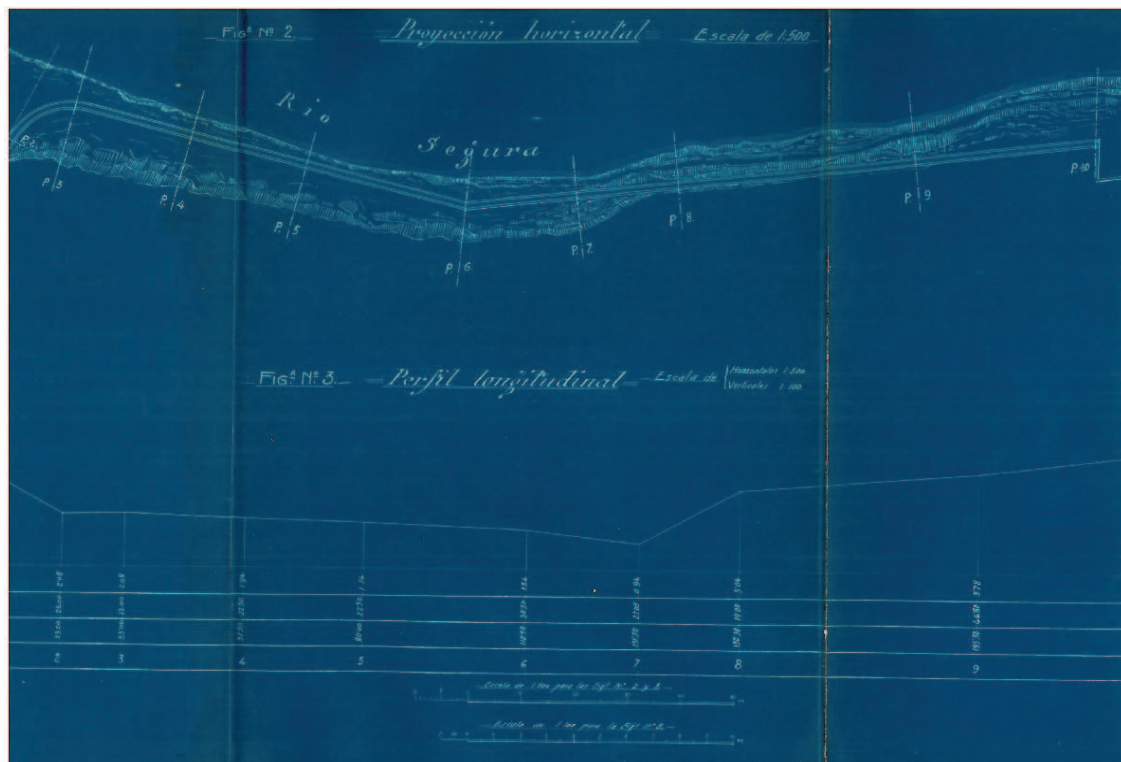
Planta de disposición del muro de contención junto al río Segura.
